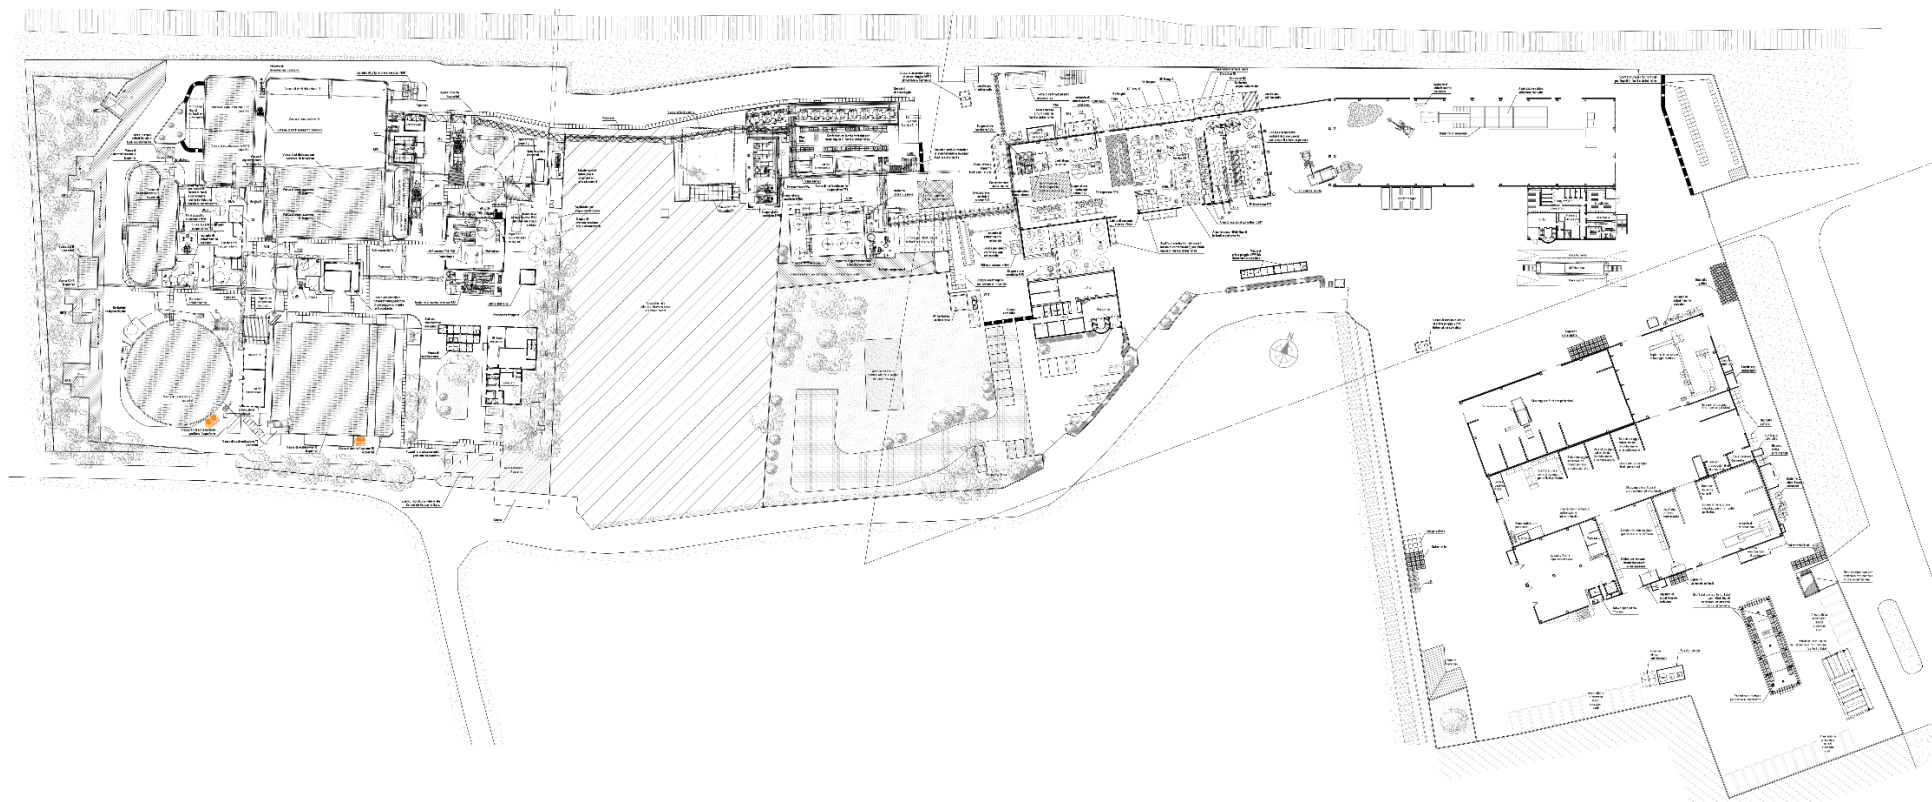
Planimetria generale dell’impianto HASI S. Croce – via Malpasso
